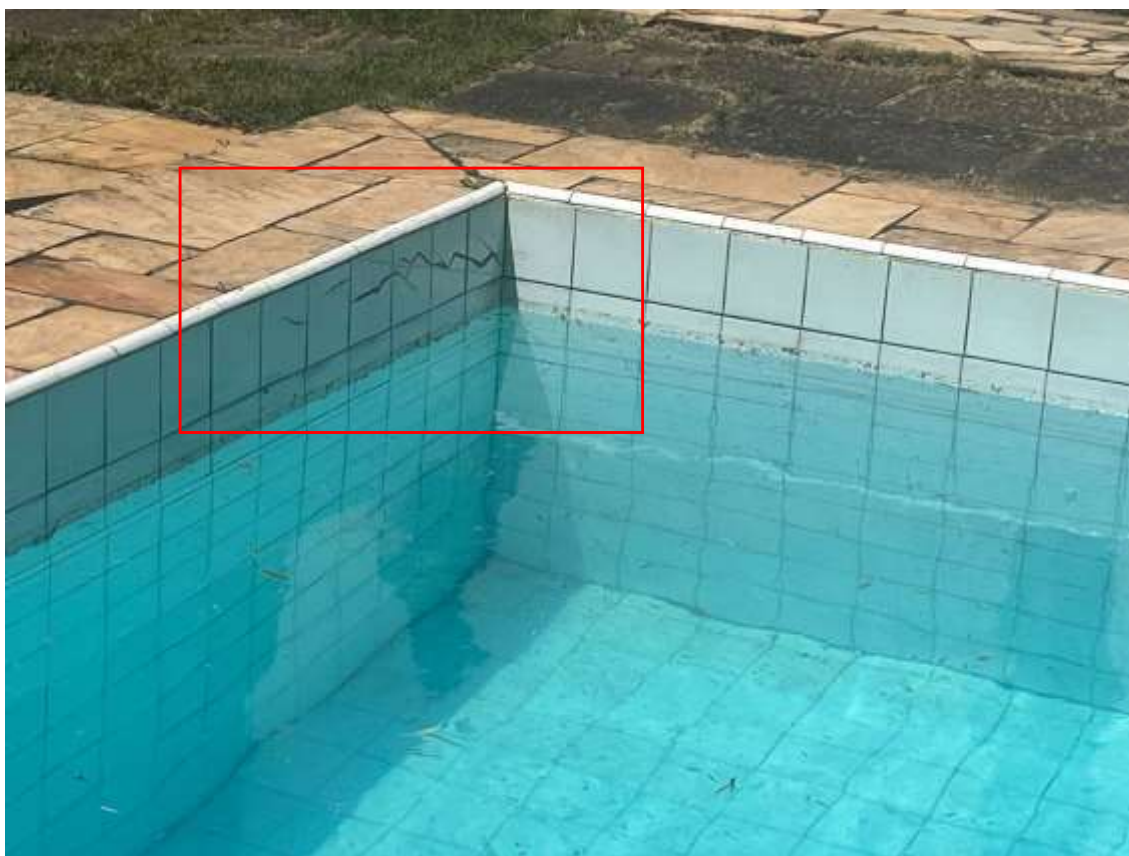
Detalhe da piscina com constatação de exemplo de rachaduras, conforme marcação em vermelho.
